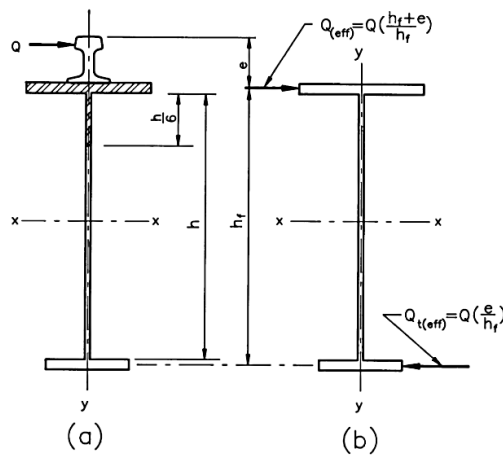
Empuje lateral efectivo y área efectiva resistente en vigas de sección abierta
